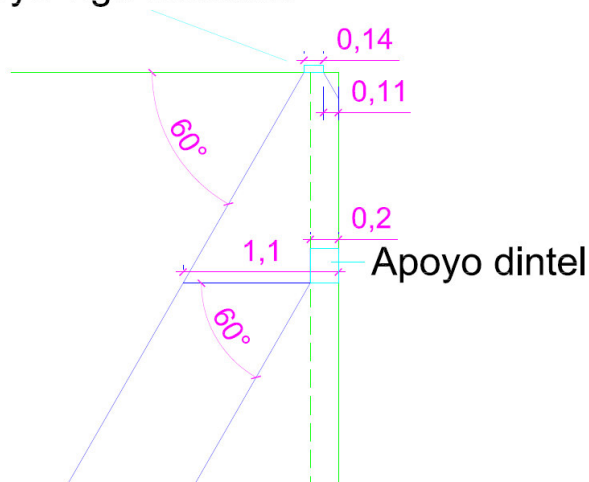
Figura V: Alzado de esquina de muro interior que recibe cargas puntuales de la viga metálica de cubierta y el dintel del muro de carga perpendicular (solape de cargas)
